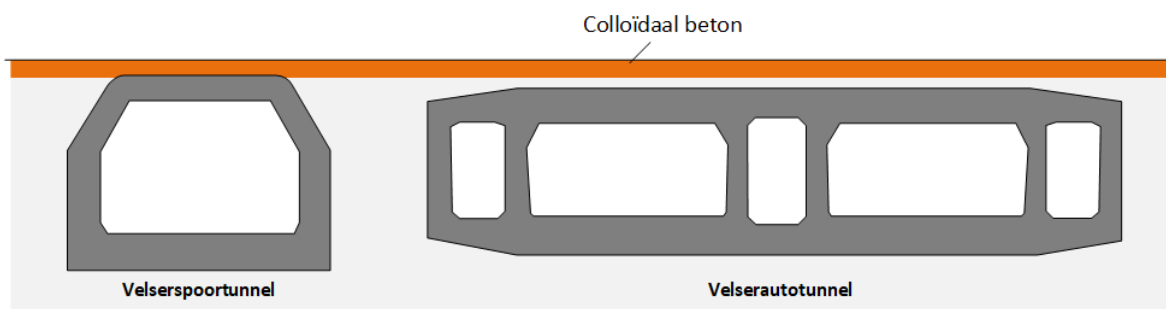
Variant 1 – Vrijdragende beschermingsconstructie (afmetingen doorsnede zijn orde-grootte).
